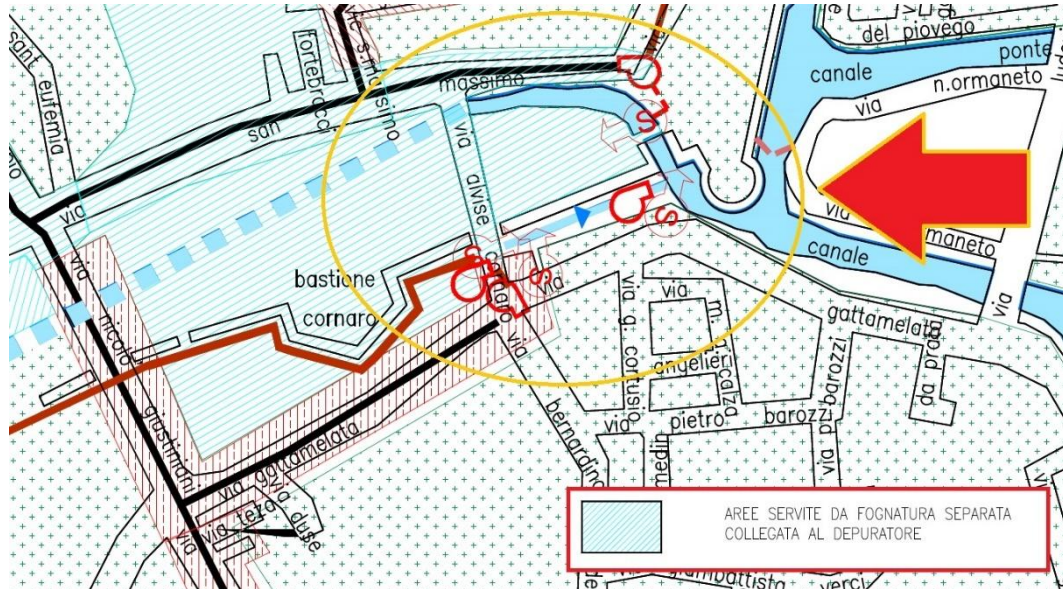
Estratto della planimetria delle reti servite da fognatura separata (fonte Acegas)
